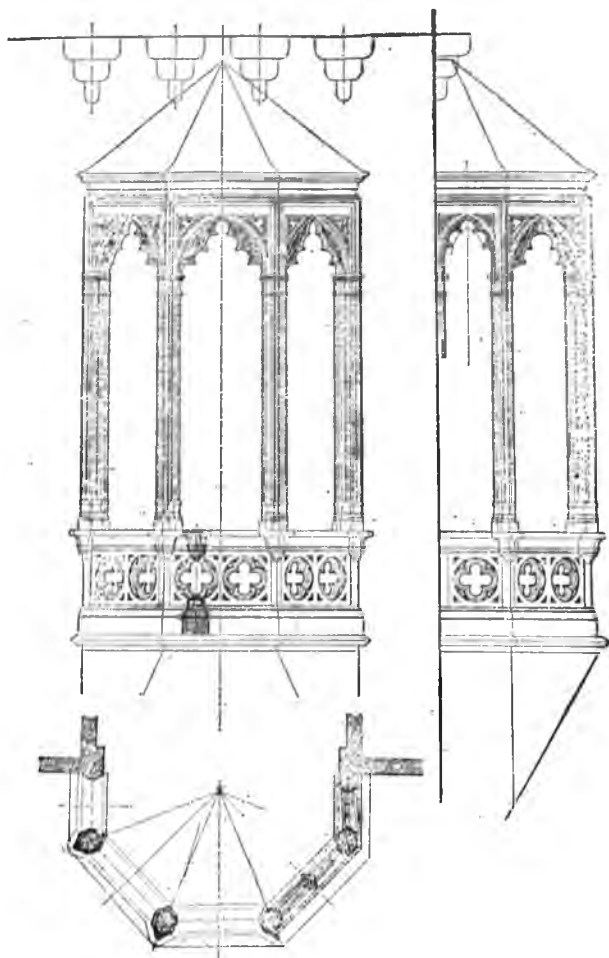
Estudio para la restauración de un mirador. No están señalados en los planos los elementos originales.
